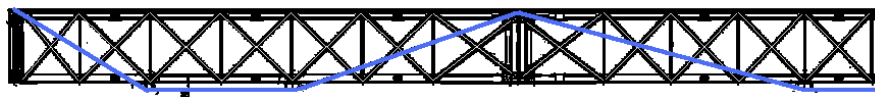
Exemplo do reforço de um tabuleiro metálico por aplicação de pré-esforço.
